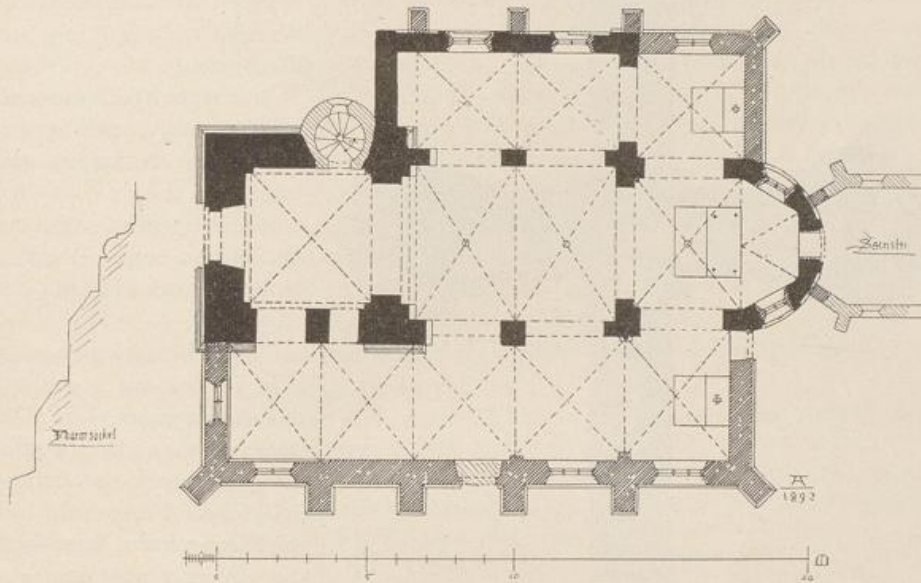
Esch. Grundriss der Pfarrkirche.
